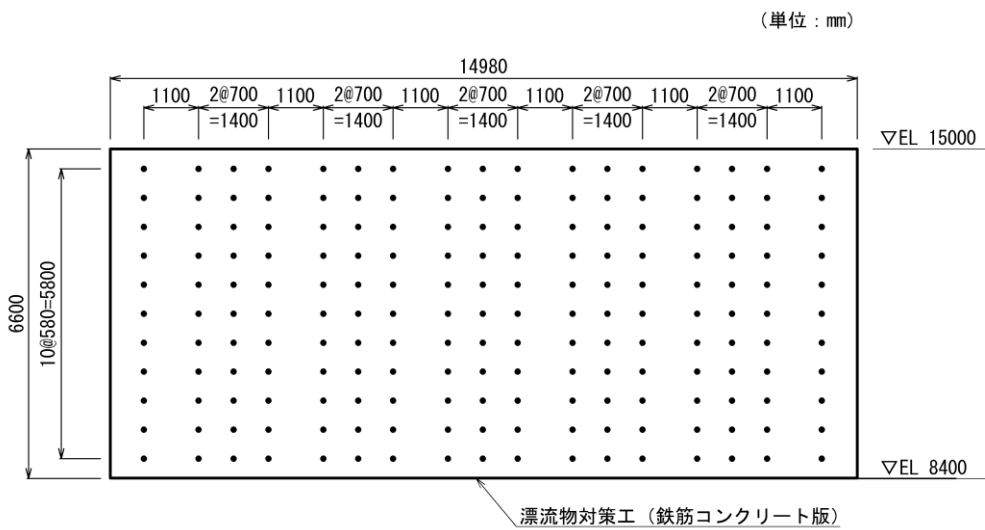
(1) 漂流物対策工 (鉄筋コンクリート版) のアンカーボルト配置図 (正面図)
